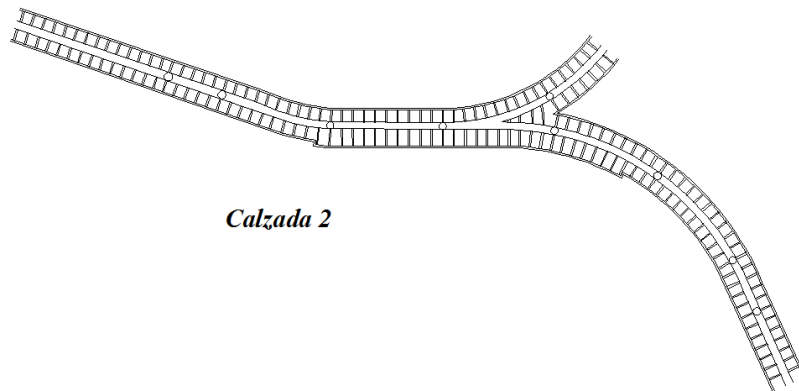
Plano mapeo de patologías de las Vigas.
